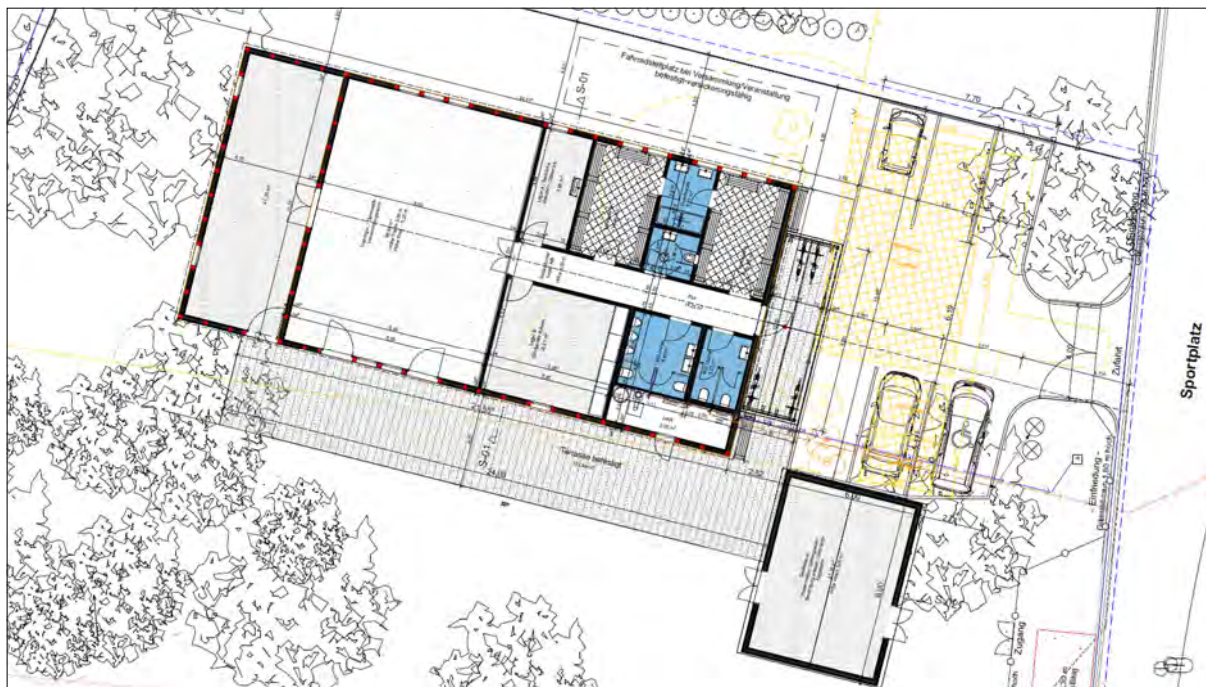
Erdgeschoss Lageplan – Planungsstand 23.04.2017 (BauArt GbR Architektur und Design)
